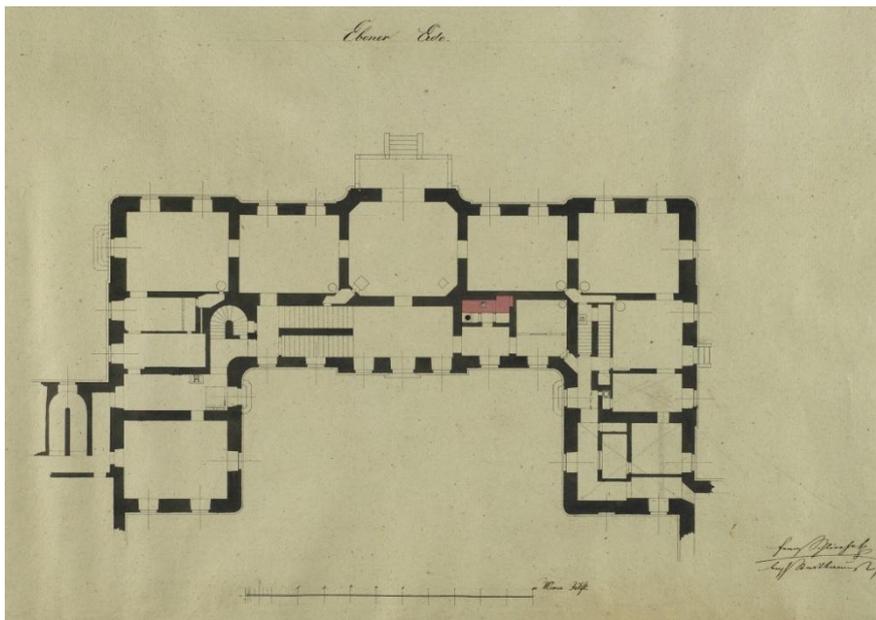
Franz Schlierholtz, Gartenpalais Modena, EG Grundriss des Corps de logis, um 1843, HHStA, Wien.
